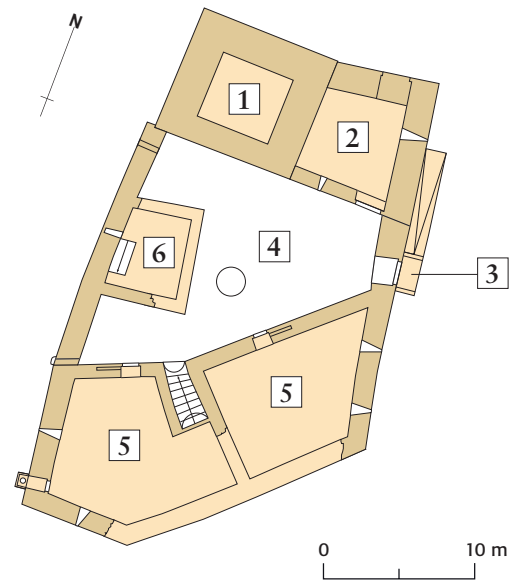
Brien/Brinzauls, Burganlage Belfort. Grundriss 1.
